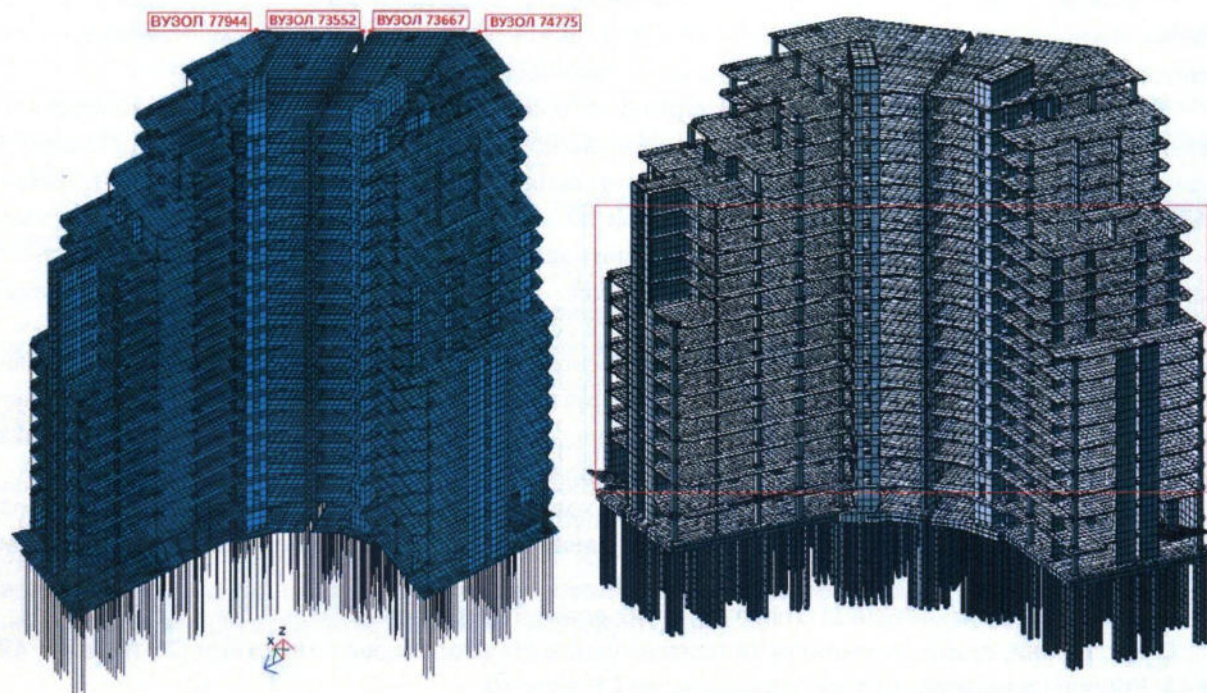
Загальний вигляд розрахункової моделі будівлі
